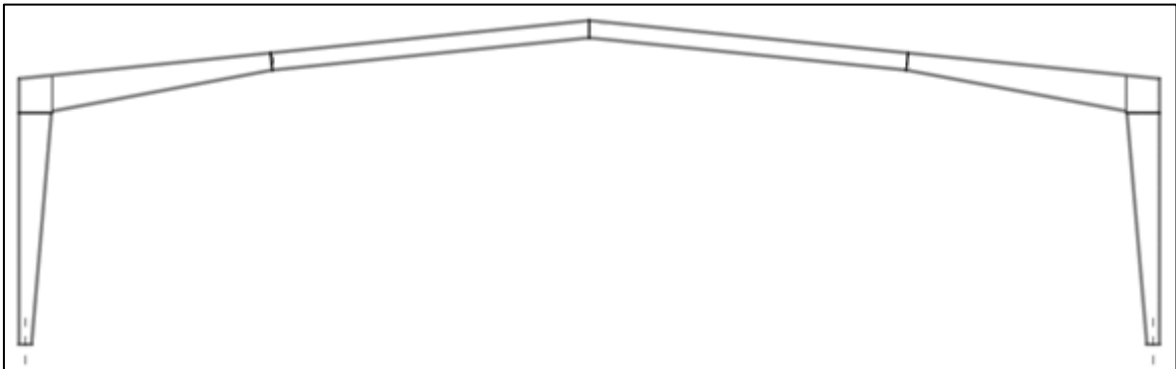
Pórticos triarticulado con viga de más de dos piezas
